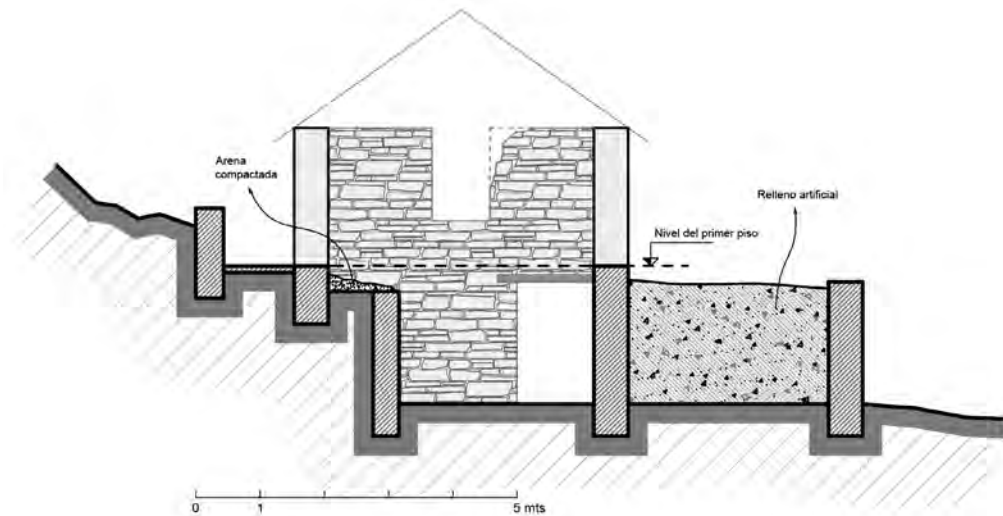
Corte transversal de la Estructura II, en que se ve el apoyo sobre el cerro.
